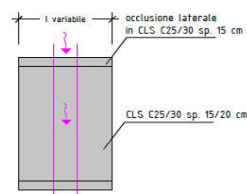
Tipologia di attraversamento stradale e cavalcafosso in progetto
